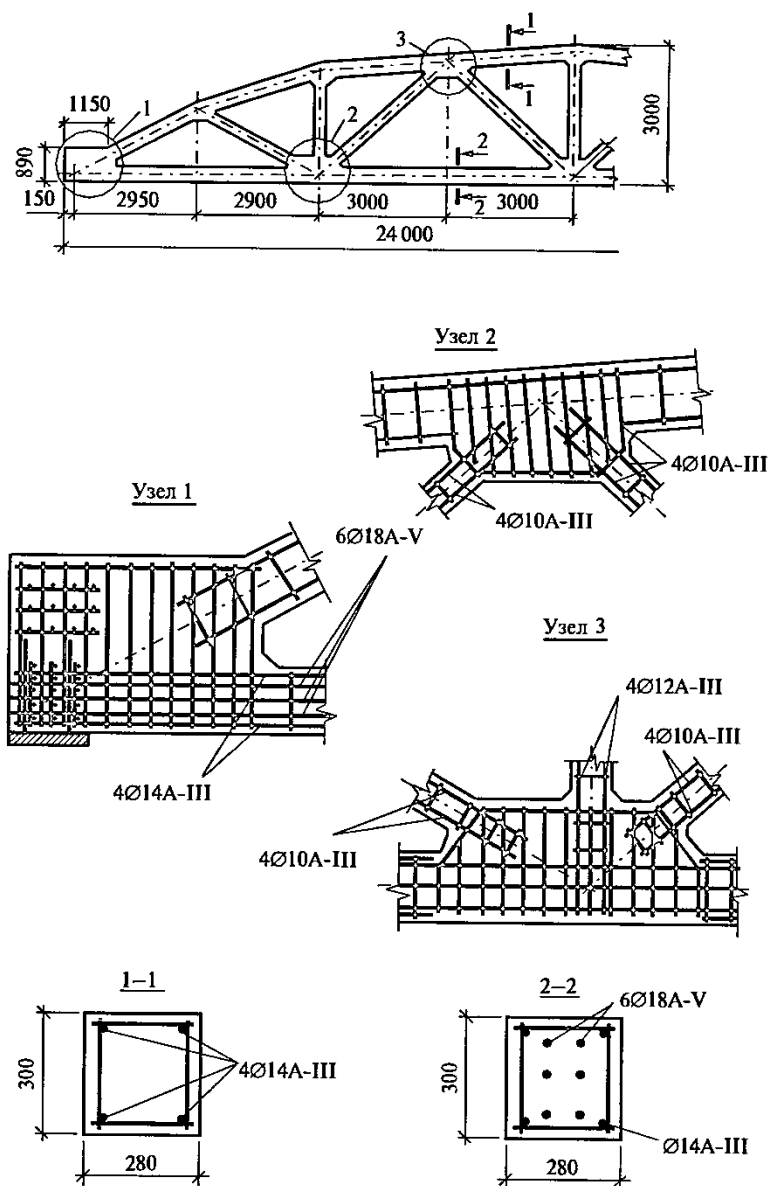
Железобетонная сегментная ферма пролетом 24 м
